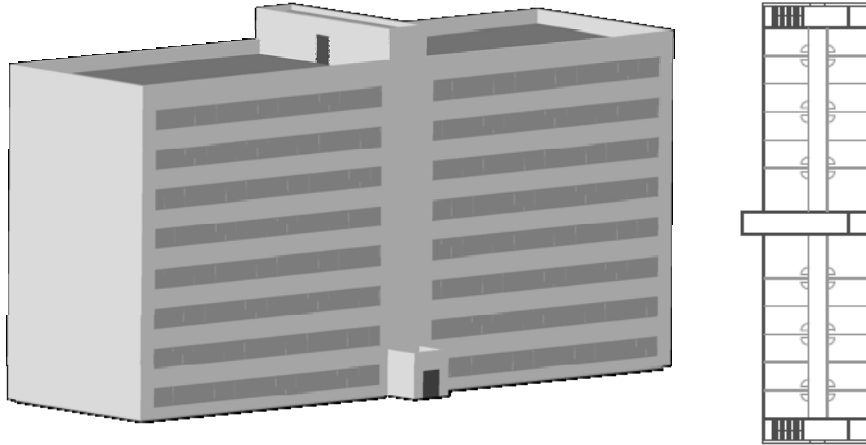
Ansicht und Grundriss des simulierten Bürogebäudes
